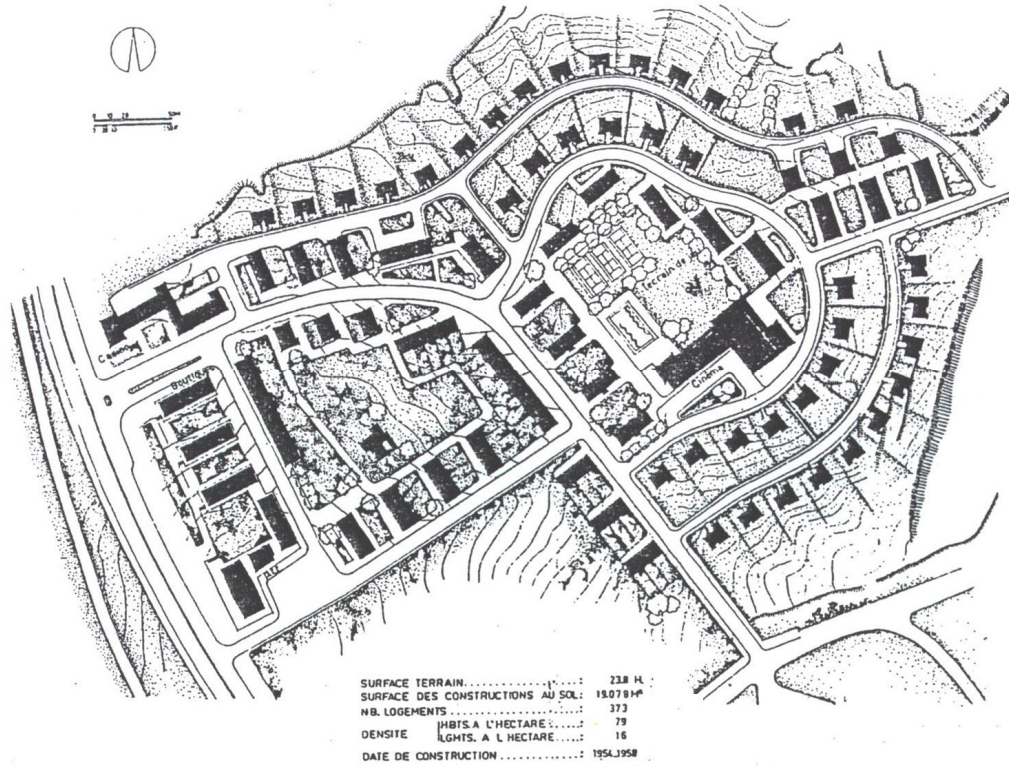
1. Levent Mahallesi Vaziyet Planı (Emlak Kredi Bankası Arşivinden)
